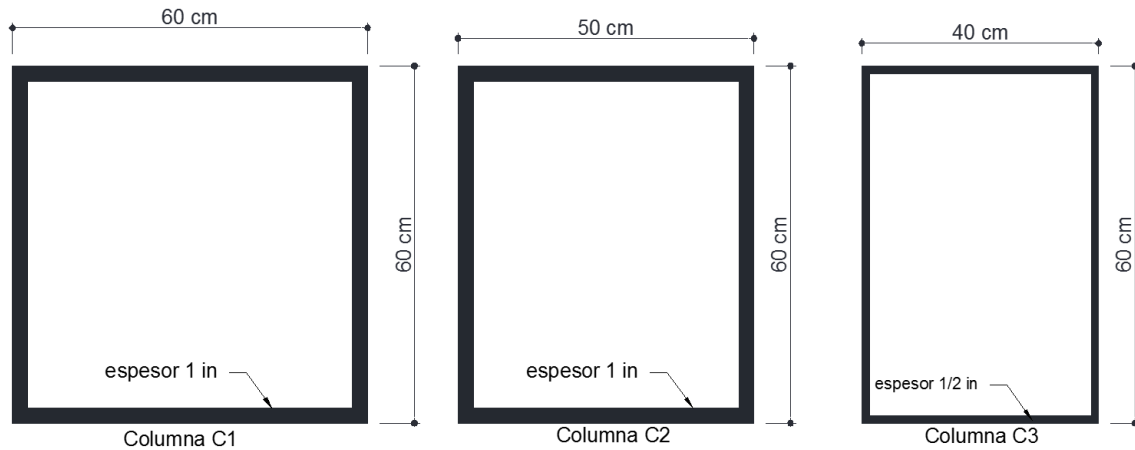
Sección transversal de las columnas de la estructura de acero.
